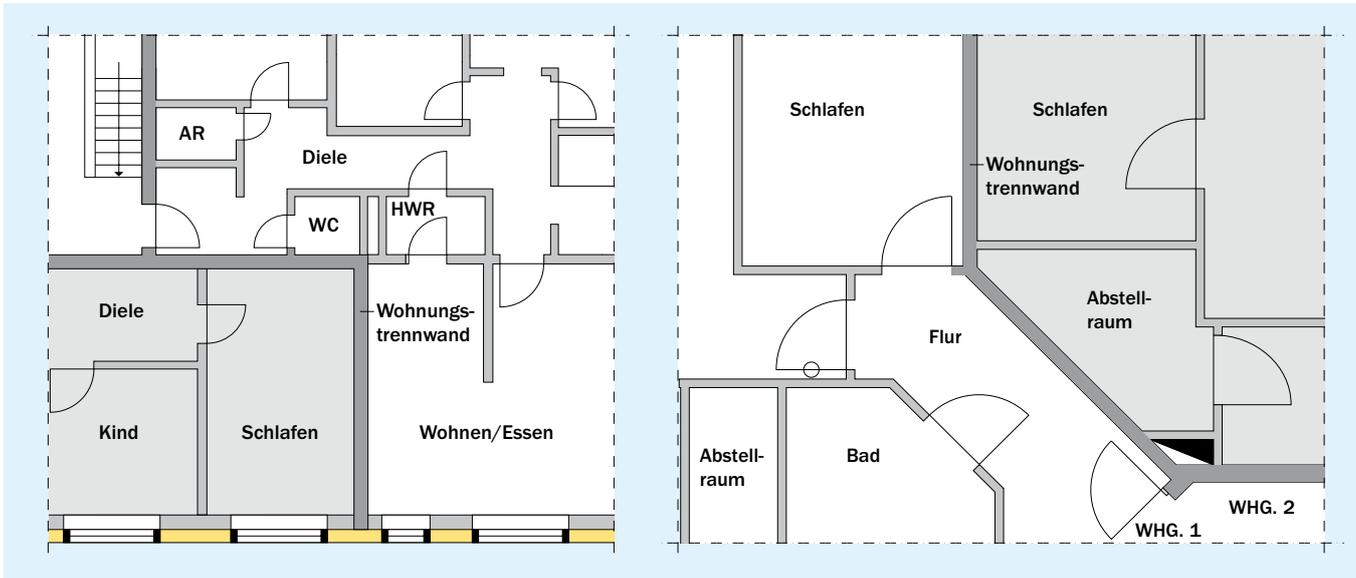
Grundriss-Situationen mit abgewinkelten Wohnungstrennwänden
